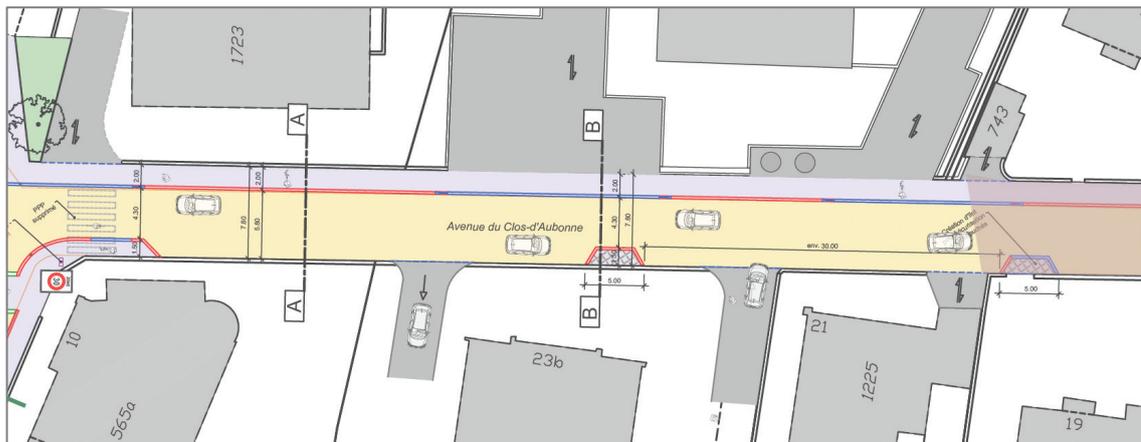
sécurisation des accès latéraux, fond de plan extrait du plan MCR
